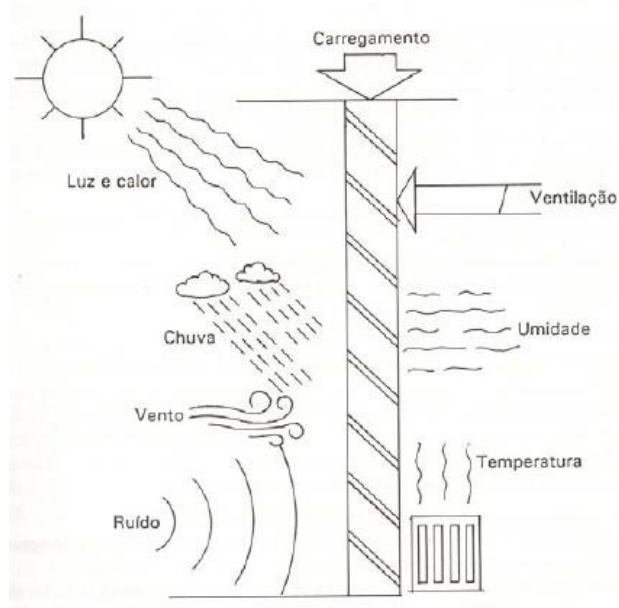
Perfil de alvenaria de vedação e revestimento.
